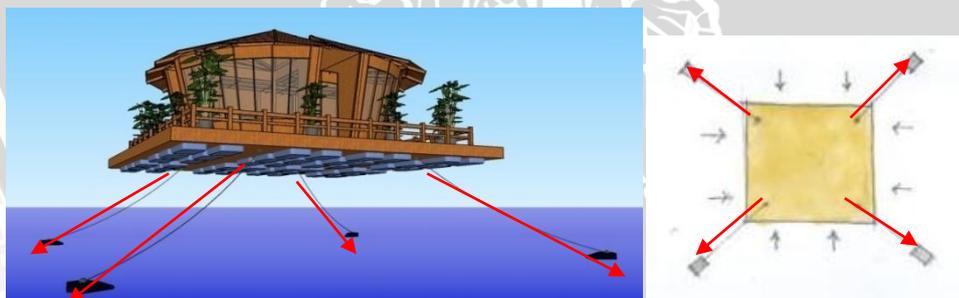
59 Detail Sambungan pada Plat Apung
